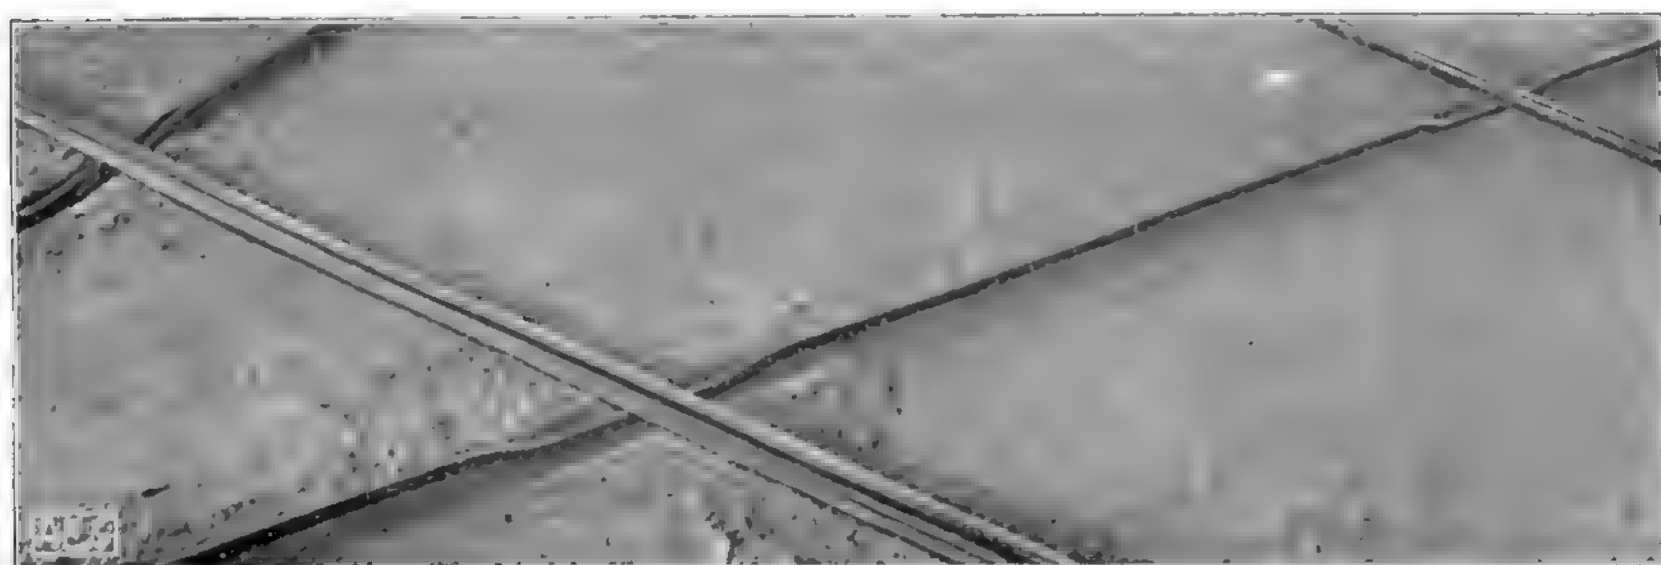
Kreuzung von Stahlpanzerrohren auf der Betondecke.
